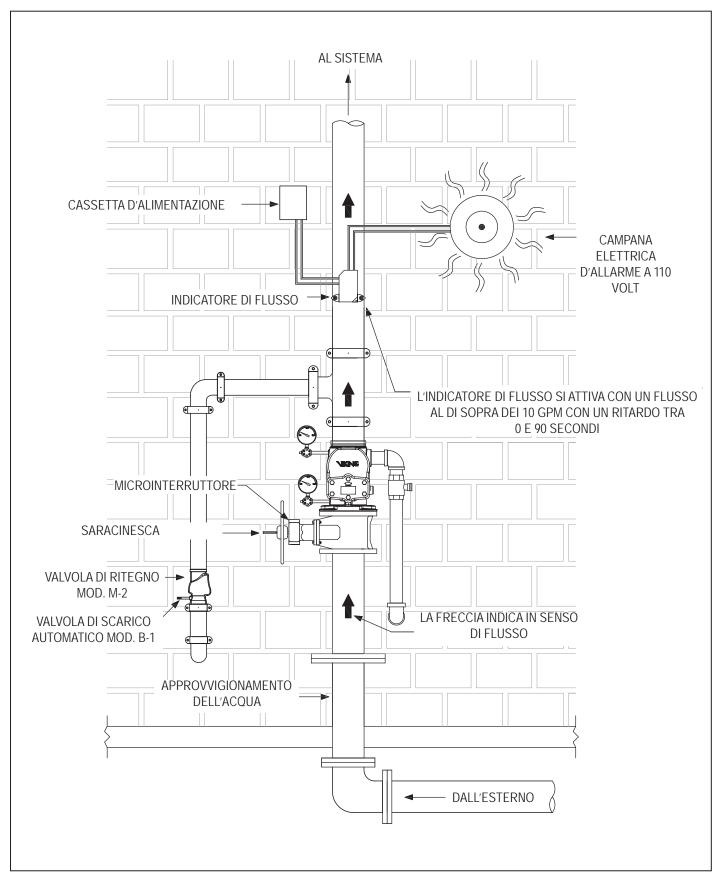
Circuito che utilizza una valvola Viking Easy Riser mod . E-1
